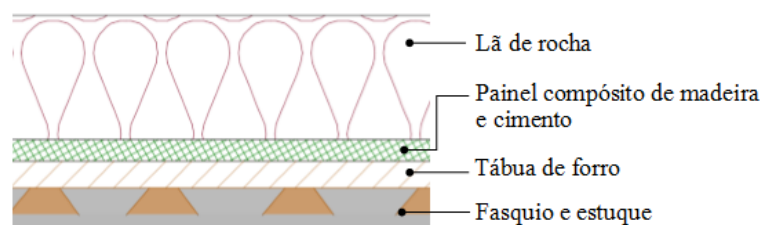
Esquema da solução 2 de laje de esteira (corte transversal) e legenda
